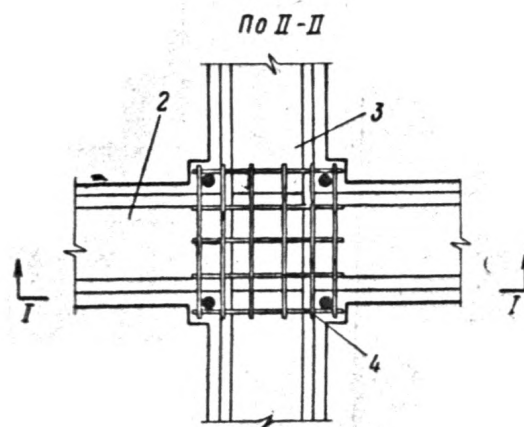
Армирование узла сетками, расположенными нормально к оси колонны
